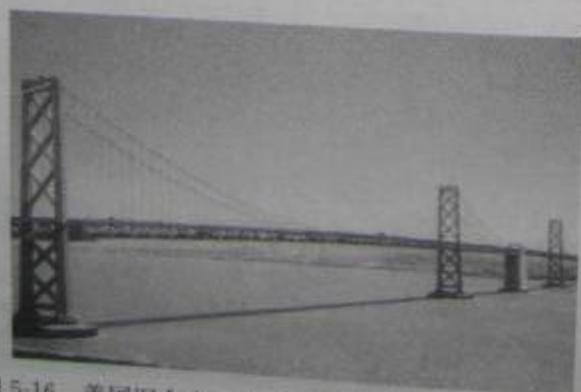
美国旧金山—奥克兰海湾大桥(尺寸单位:m)
